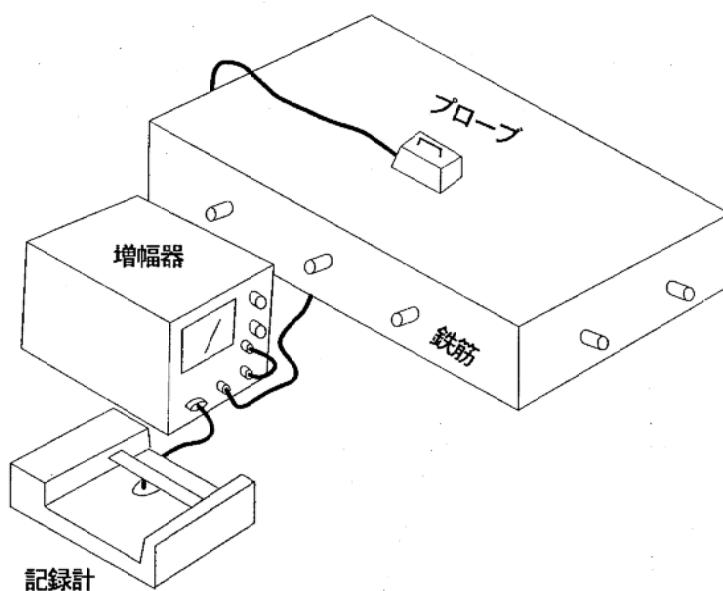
コンクリート構造物の非破壊鉄筋検査装置
